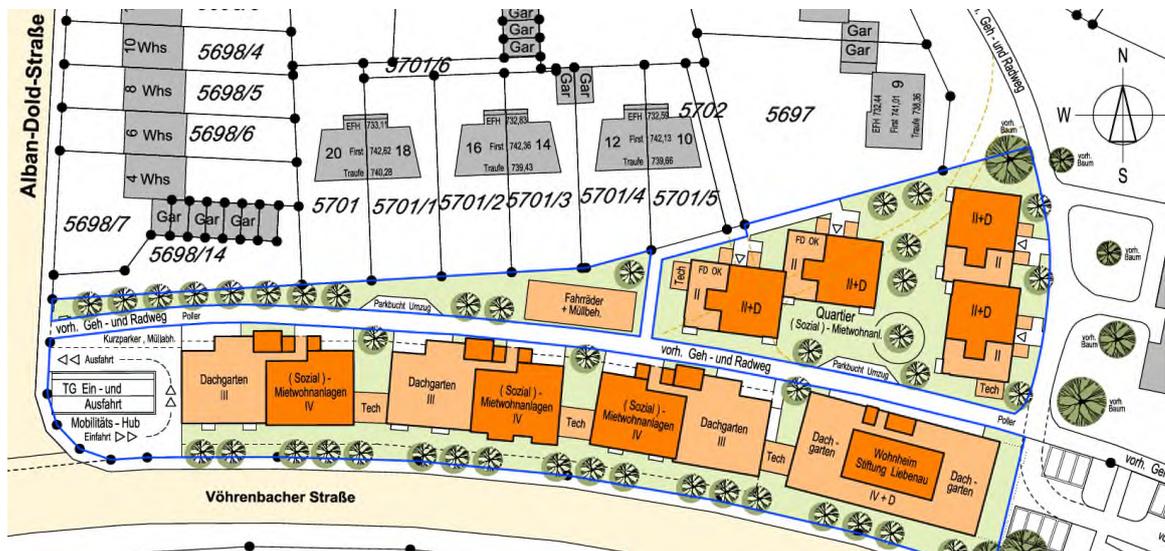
Lageplan ‚Wohnbebauung Vöhrenbacher Straße‘ in Villingen-Schwenningen (Stand 24.10.2019) [15]
